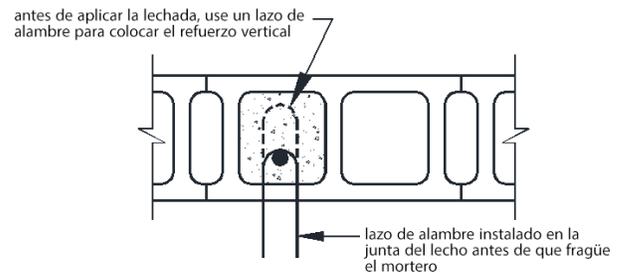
DETALLES DEL AMARRE DE REFUERZO VERTICAL
